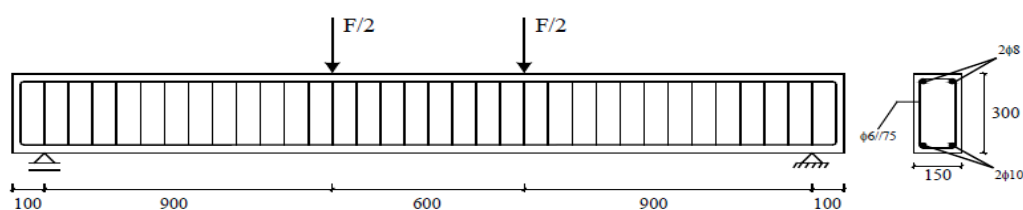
Geometria, tipo de ensaio e armaduras de aço das quatro vigas ensaiadas, dimensões em milímetros (Dias *et al.*, 2012).
